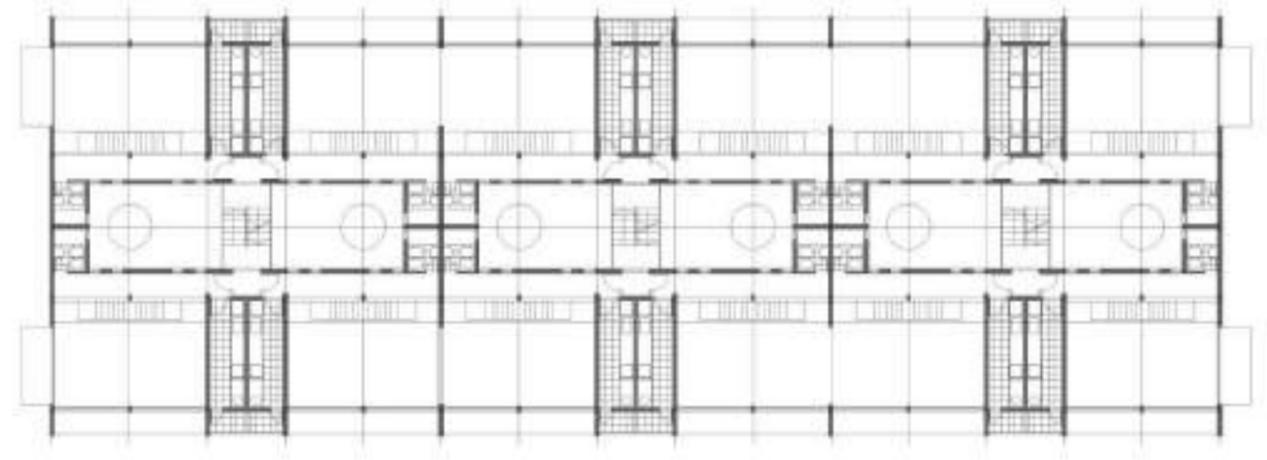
Planta de la estructura genérica sobre la que se desarrollan las diferentes U.H.
